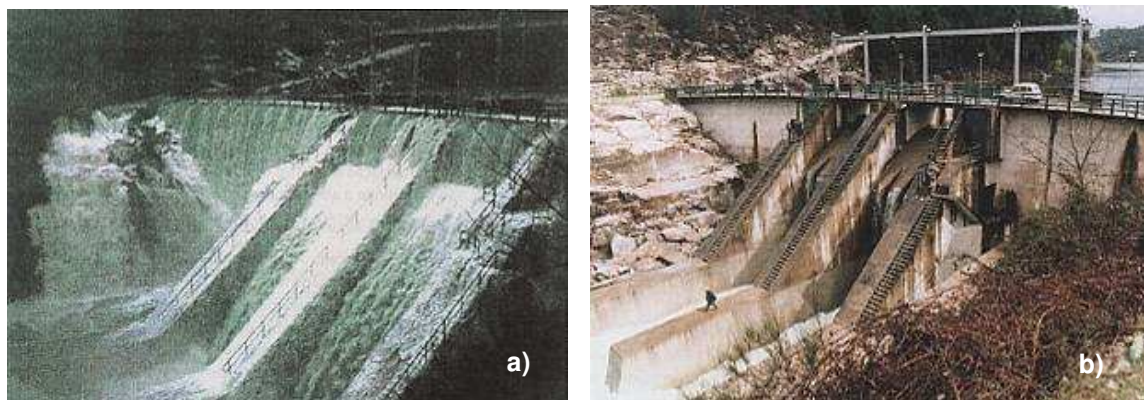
| Barragem de Fagilde: a) galgamento; b) aspeto da barragem após galgamento
